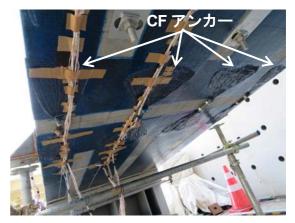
繊維シート·CF アンカー施工完了(試験体No.2)
